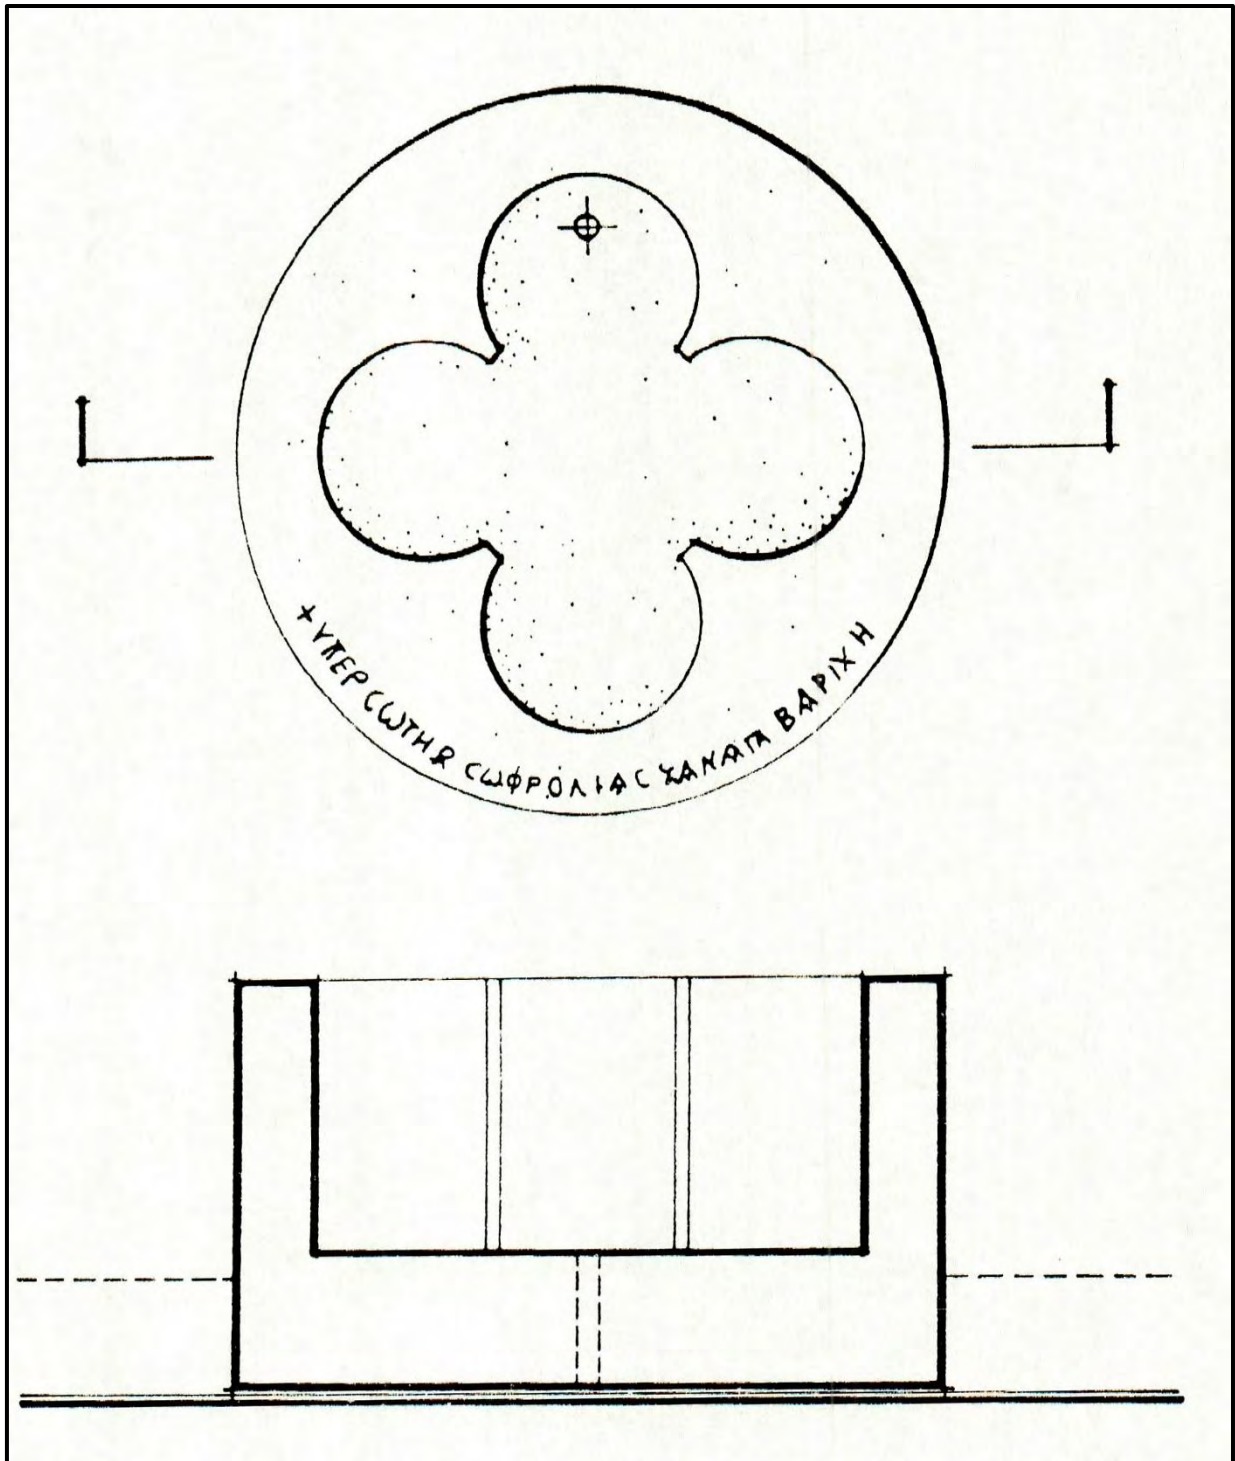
Khirbet Zachariyeh. Pianta e sezione del fonte battesimale
